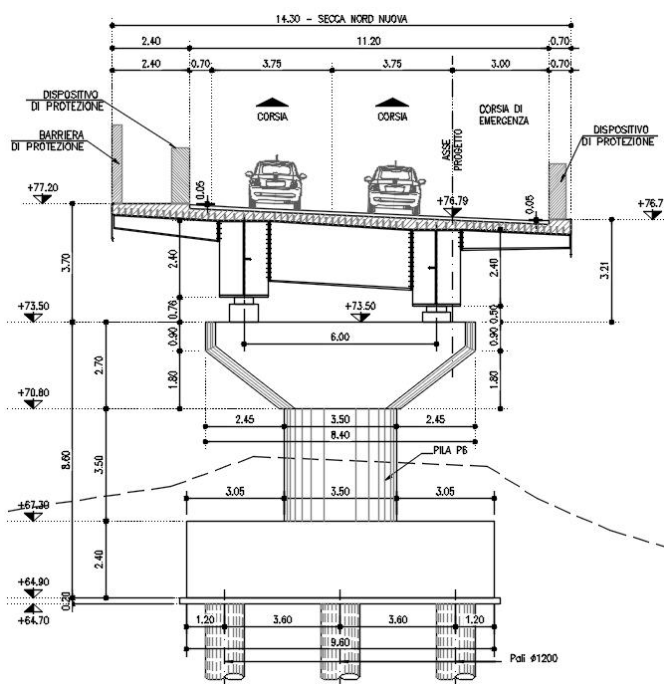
Pila a mensola - Sezione trasversale Pila P6
